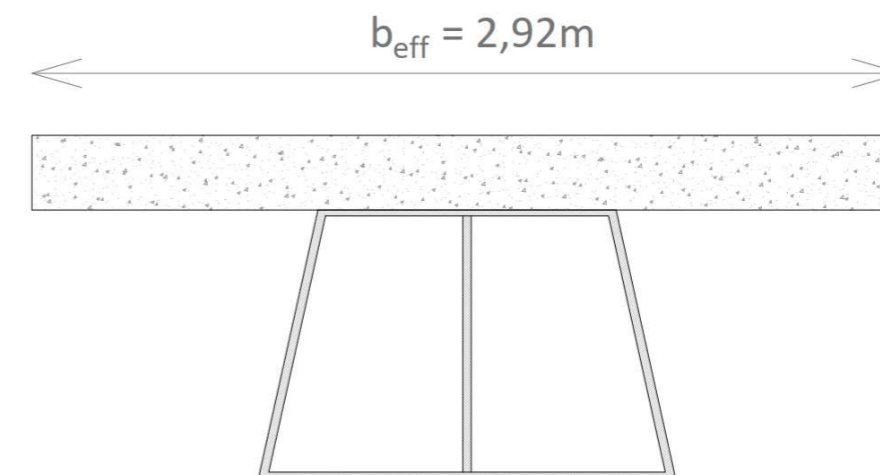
Ancho eficaz de la losa considerado para las vigas longitudinales (fuente: elaboración propia)
